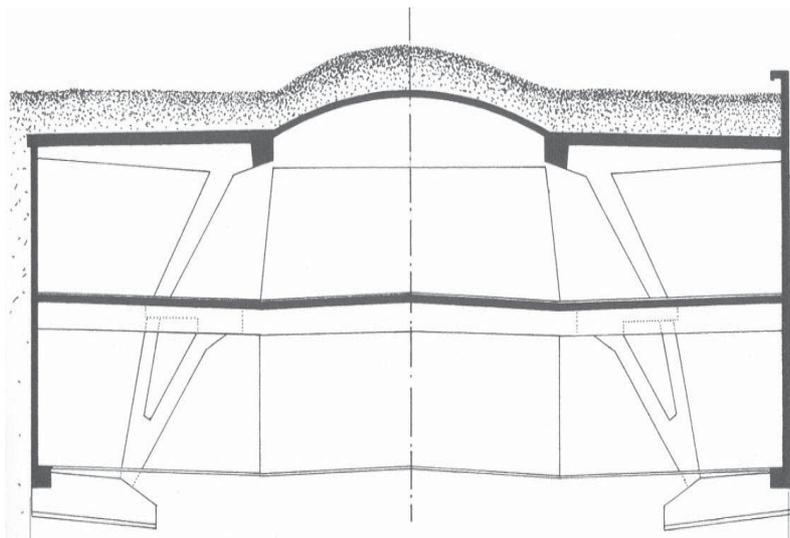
Sección transversal Garaje Zolli. Hossdorf.
